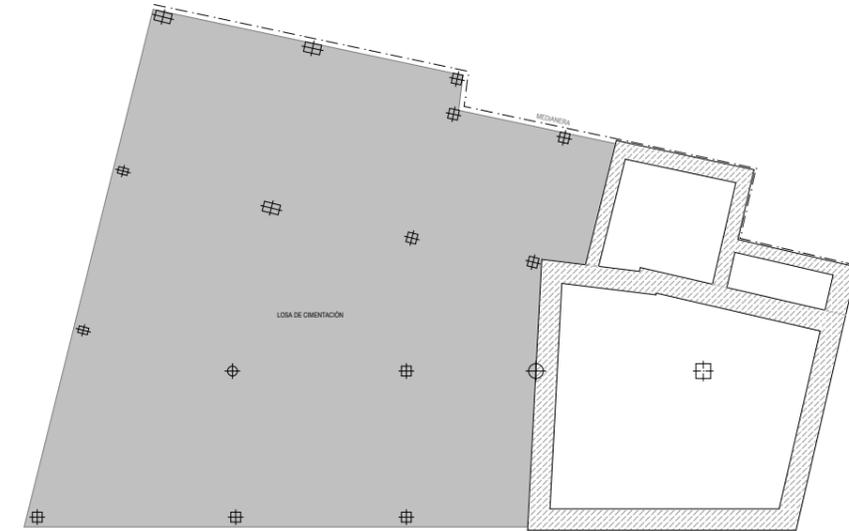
Cimentación Reconstrucción (Izquierda). Cimentación Original (Derecha).
